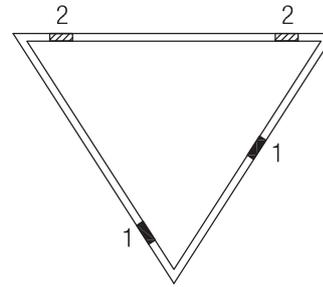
Gleichschenkliges Dreiecksfenster Festverglasung
